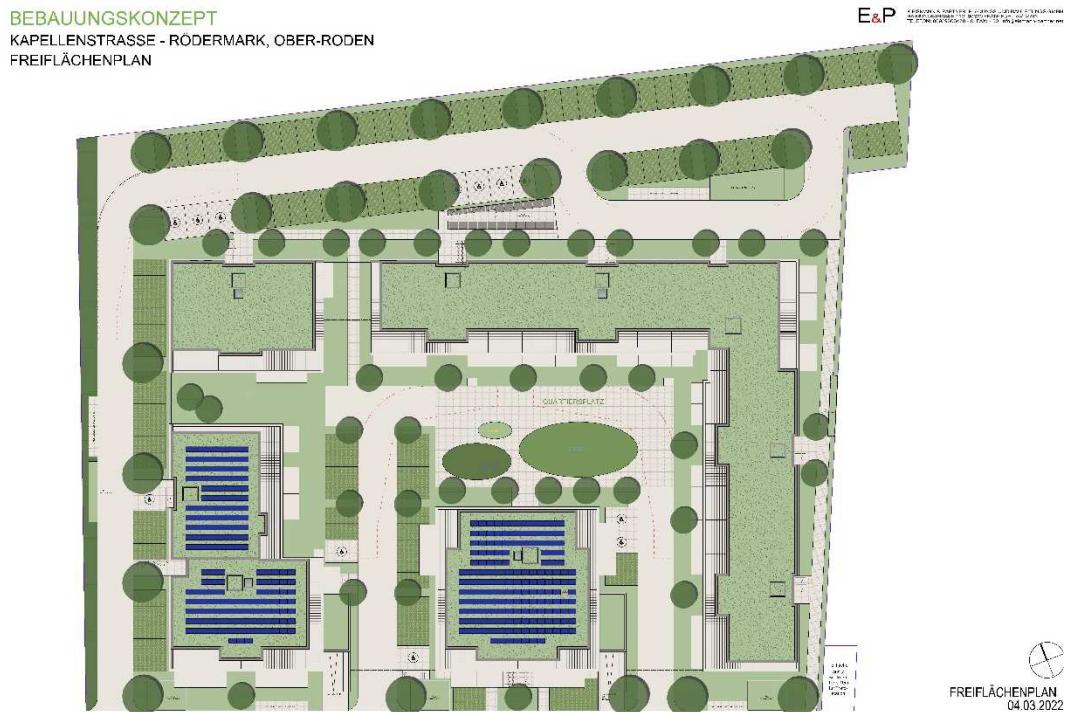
Freiflächenplan vom 04.03.2022, Klaus Eismann & Partner Planungs- und Bauleitungs GmbH, Frankfurt m,
